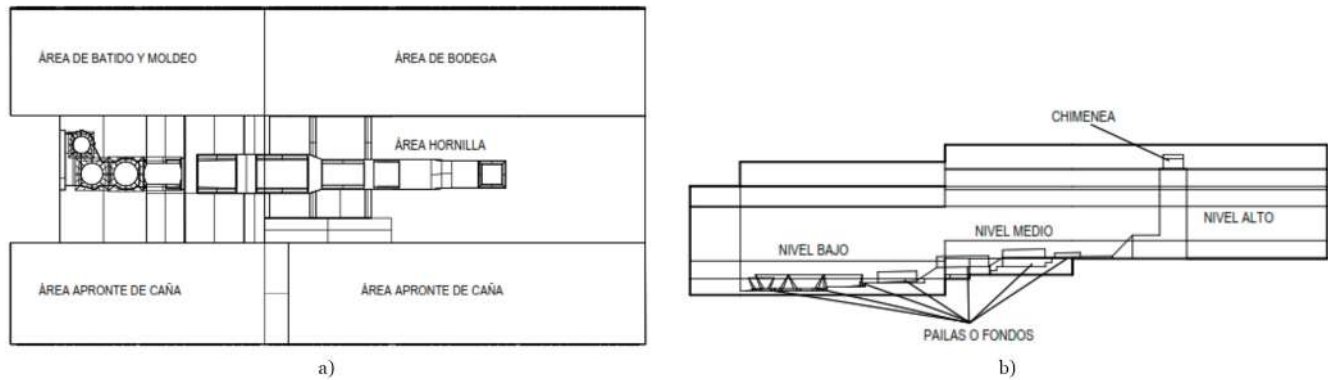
Instalación para la elaboración de panela. a) planta arquitectónica; b) fachada. Fuente: Elaboración autores
